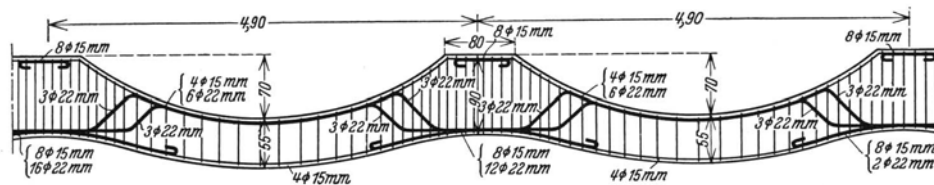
Bewehrung von verkehrten Gewölben. (Nach Fr. v. Emperger: Hdb. f. Eisenbetonbau Bd. III.)
